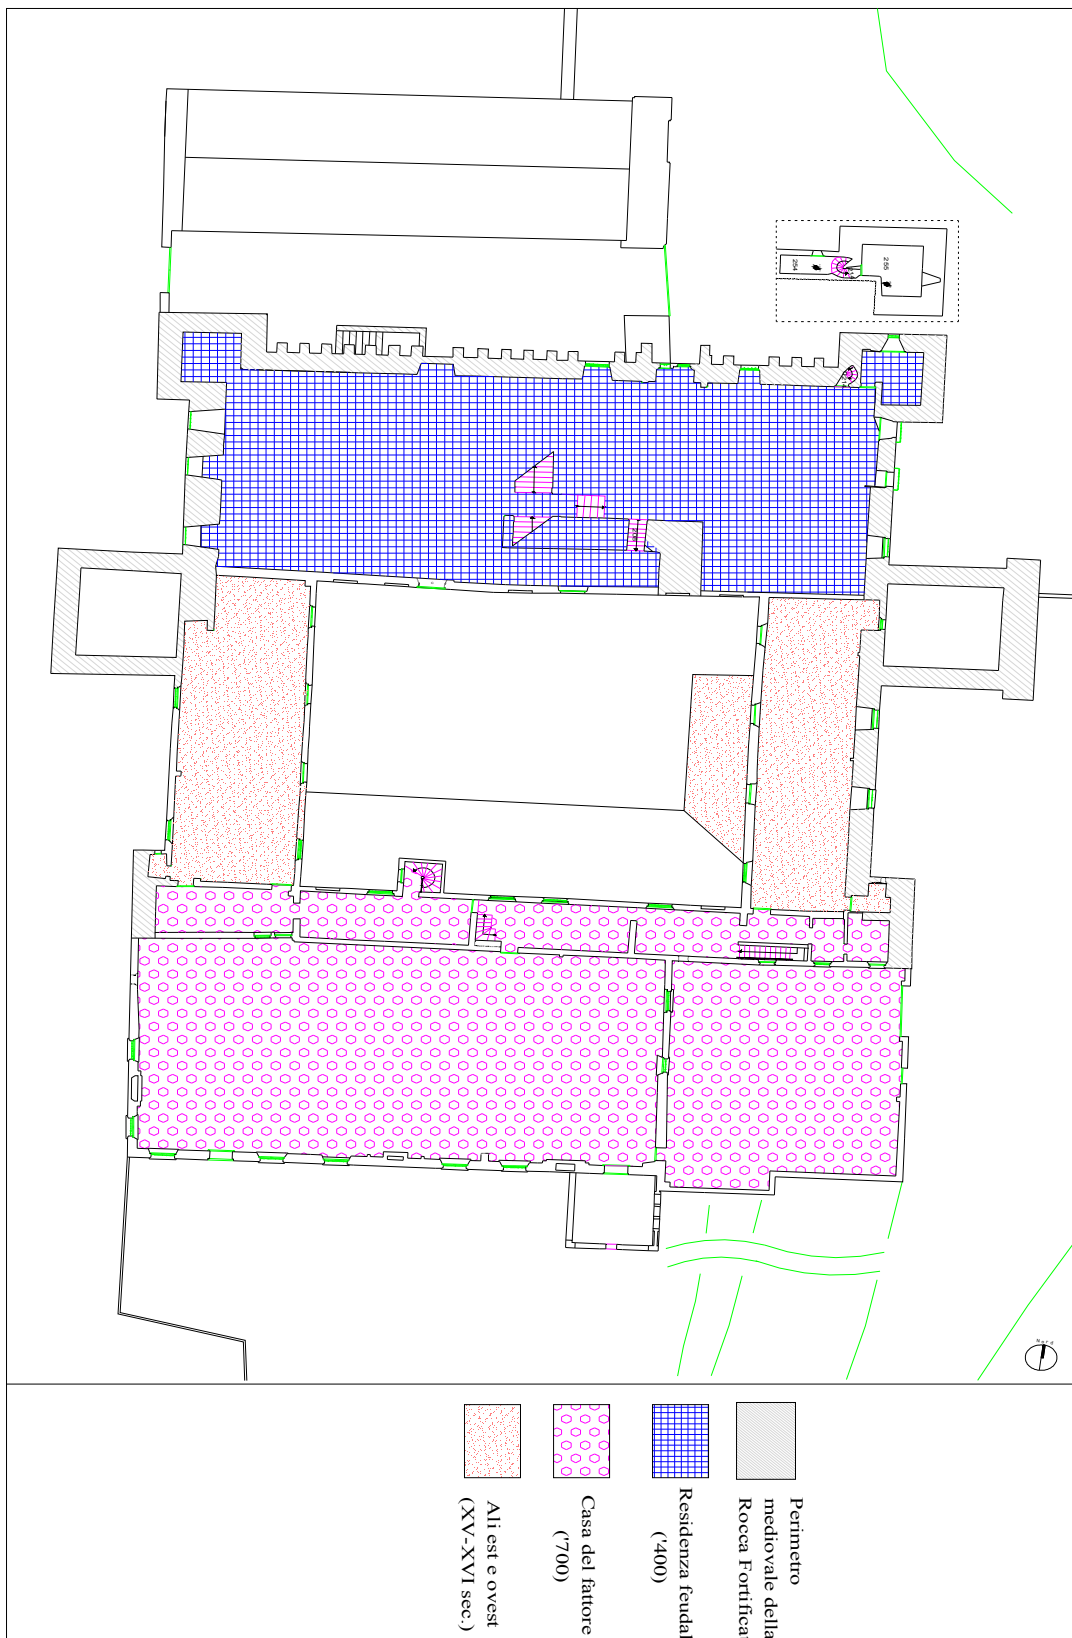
Planimetria delle fasi costruite del piano ammezzato
